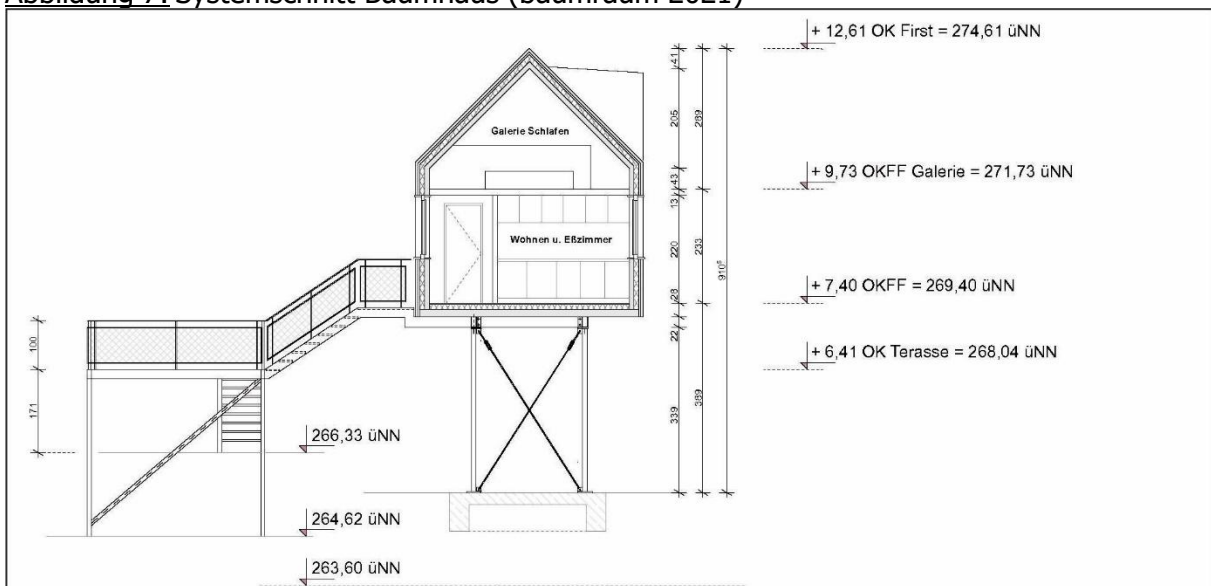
Systemschnitt Baumhaus (baumraum 2021)
